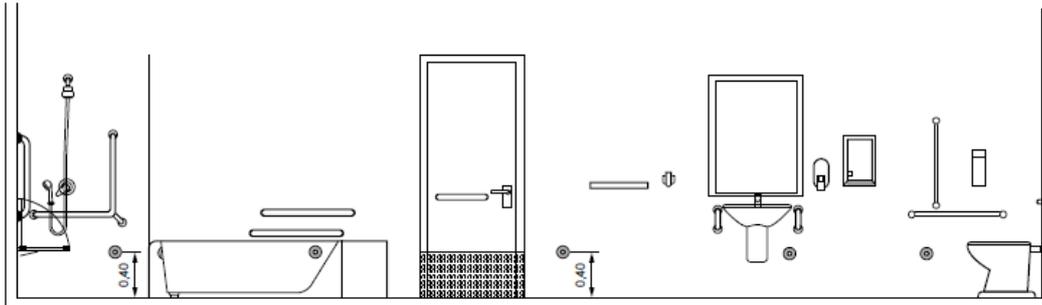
Possibilidade de posicionamento do dispositivo de alarme no banheiro – Exemplos
